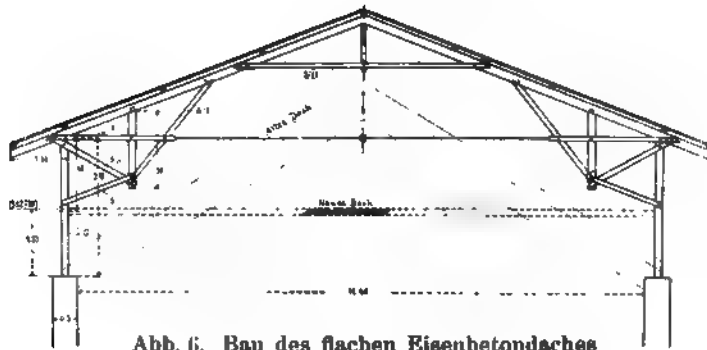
Bau des flachen Eisenbetondaches unter einem provisorischen Holzdach (s. Abb. 7).
